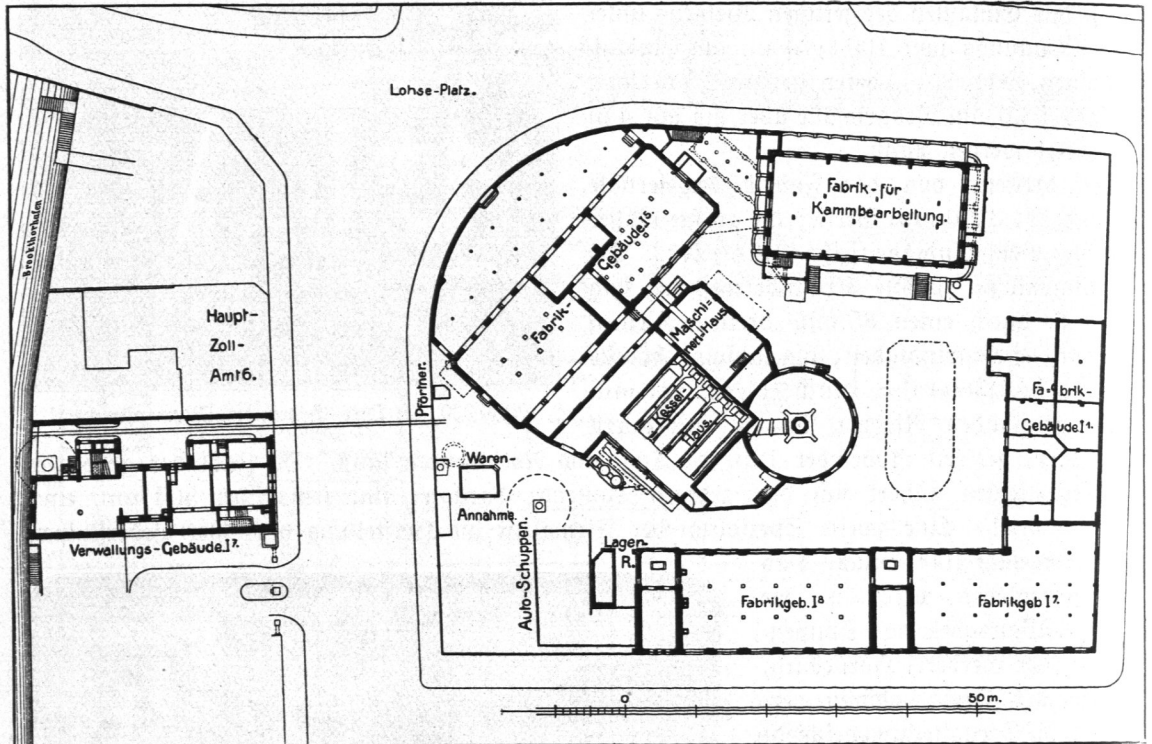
Kautschukwerke Dr. Heinrich Traun & Söhne, Lageplan.
